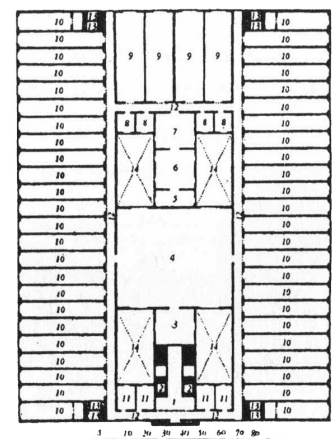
機能固定型図書館（デラ・サタンの図書館平面図）
